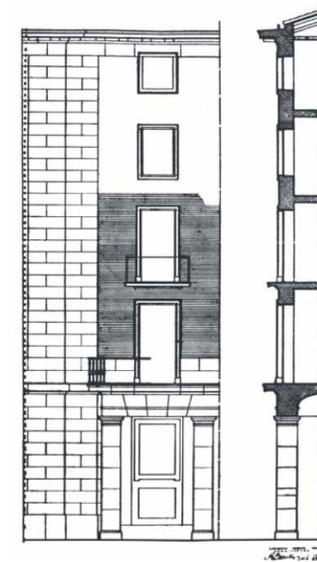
Fachada para la Hospedería del Pilar (1939) [Revista Nacional de Arquitectura, 1941]
